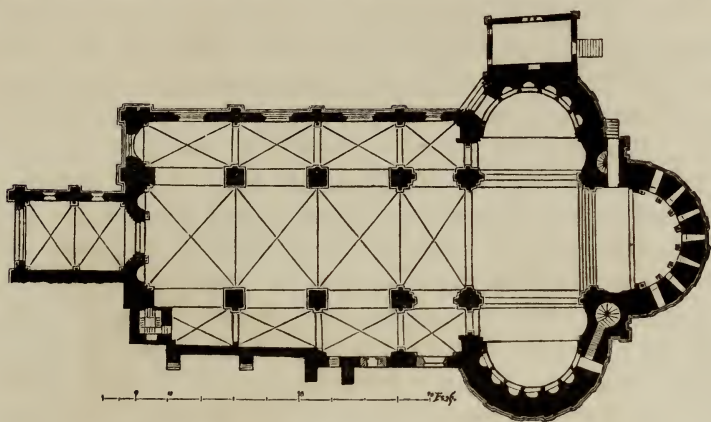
Grundriß der Kirche Groß St. Martin zu Köln.
